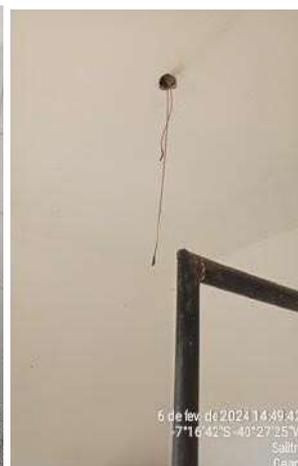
PT-01: instalações elétricas em situação precária de instalação e manutenção, com quadro danificado.
